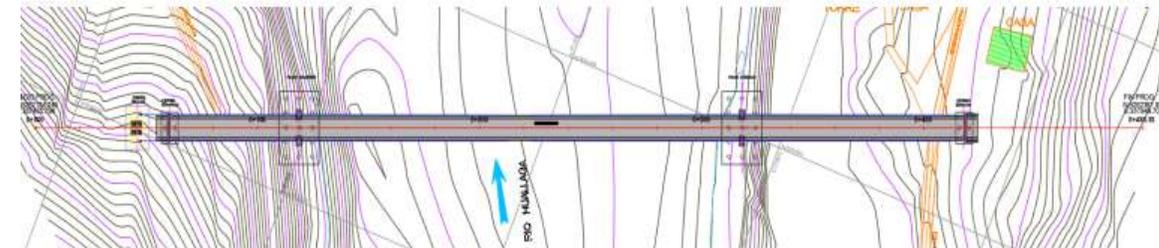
Vista en planta del Puente Atirantado Cabo Leveau.
